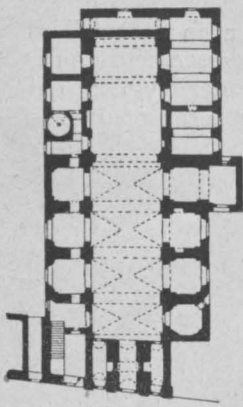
Grundriß der Barmherz. Bruder-Kirche, II. Bez.
